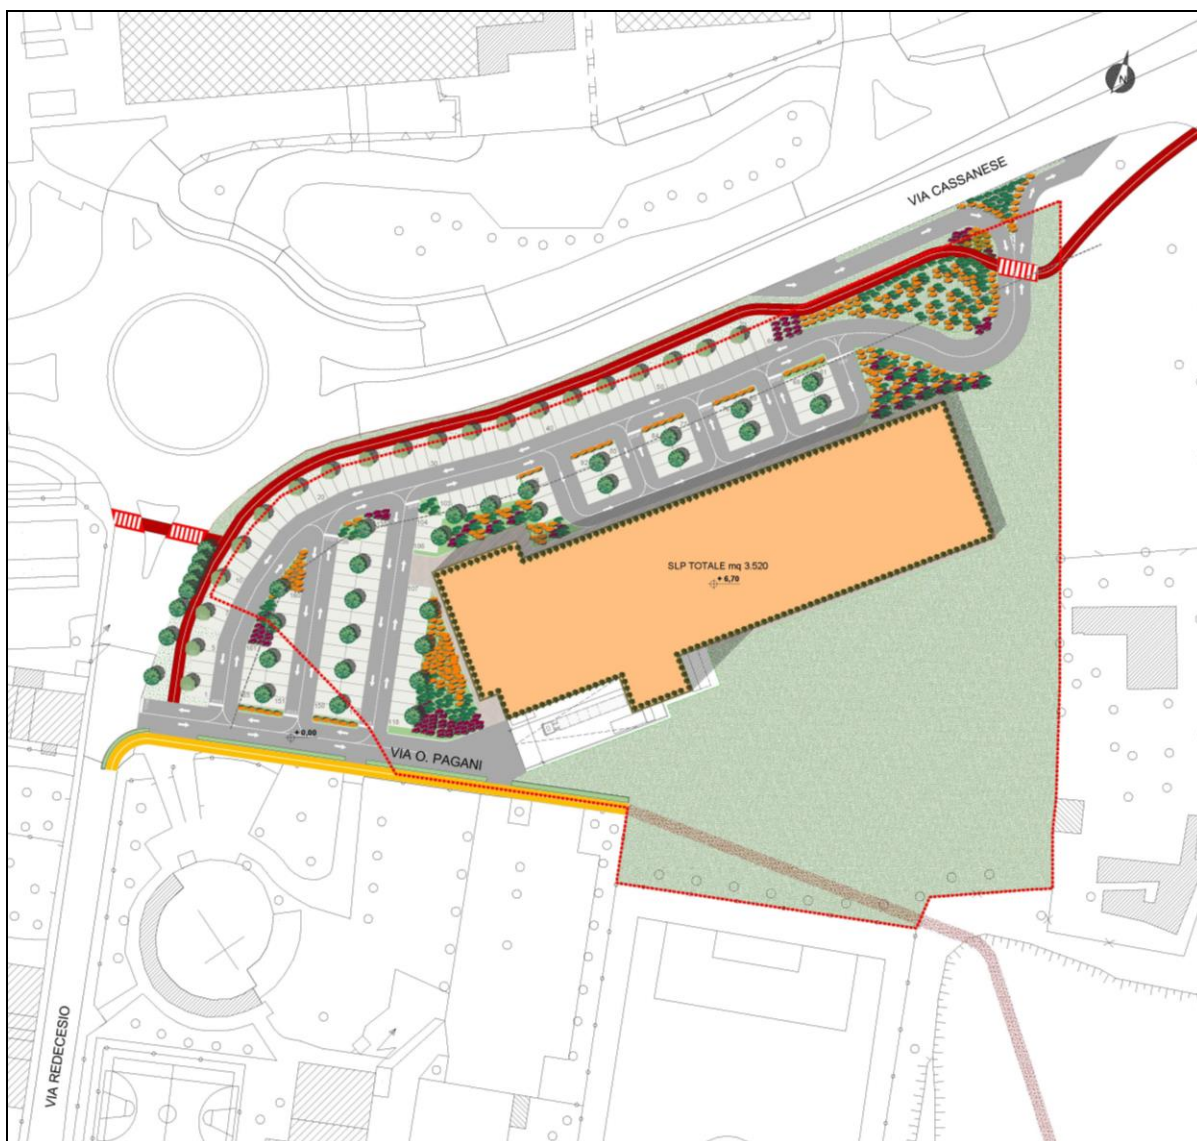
Stralcio elaborato A_05 Planivolumetrico generale di progetto adottato
